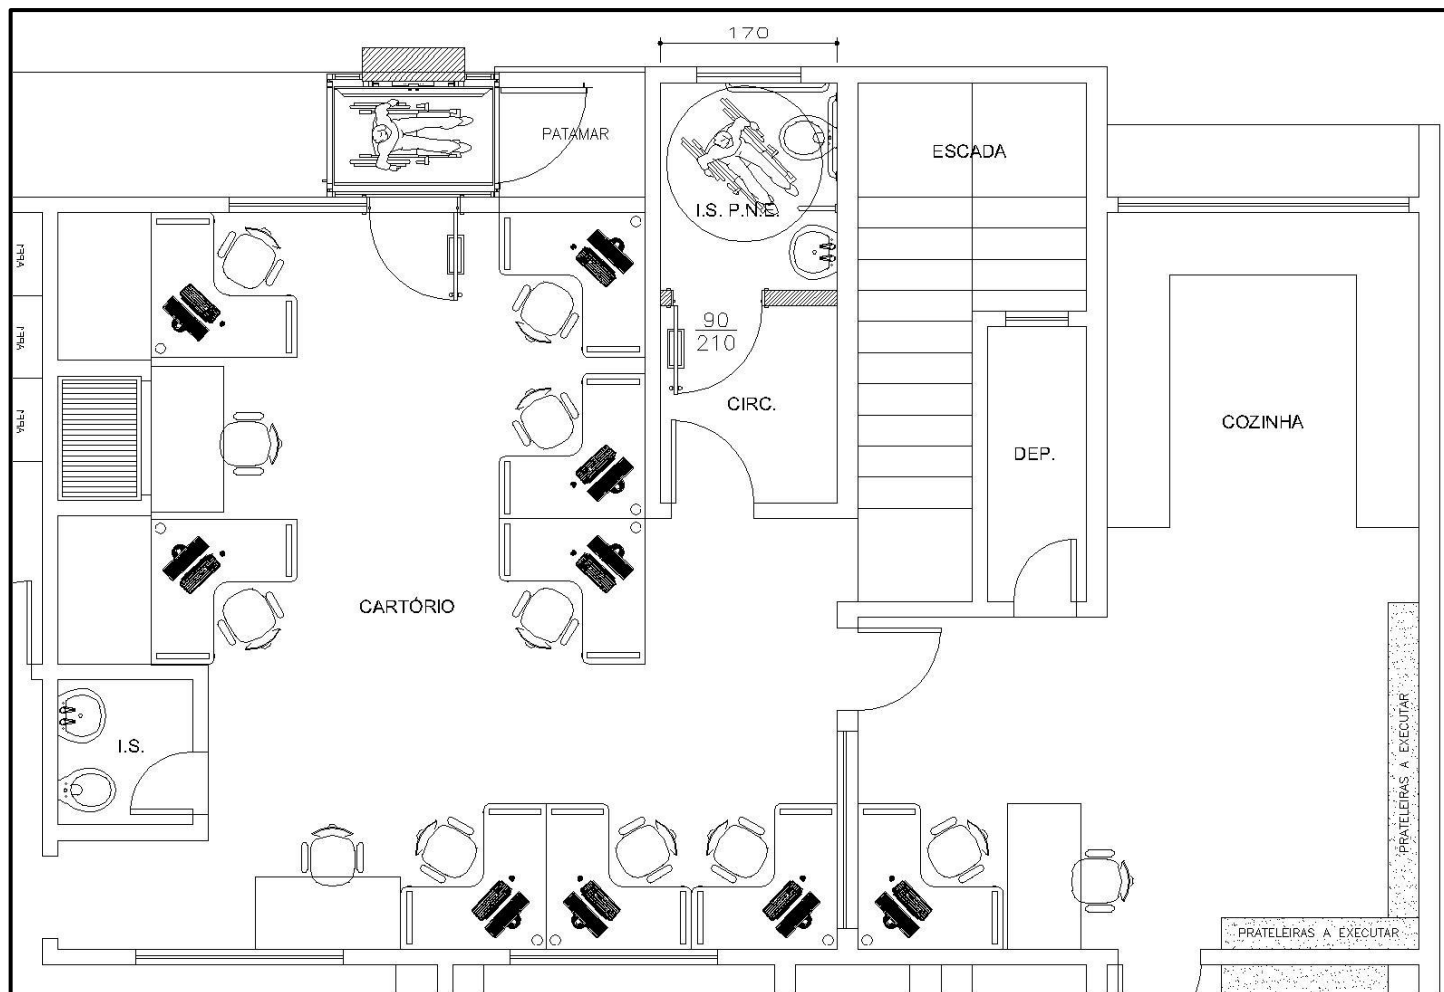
As *hachuras* representam as paredes construídas em *drywall*.
